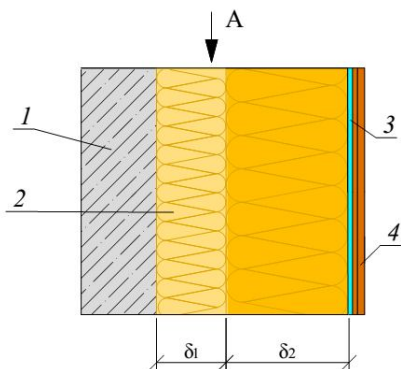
Наружная ж/б стена с внутренней тепловой изоляцией: 1 – 150 мм ж/б плиты; 2 – тепловая изоляция; 3 – пароизоляция; 4 – облицовка; 5 – рейка с шагом 0,6 м
